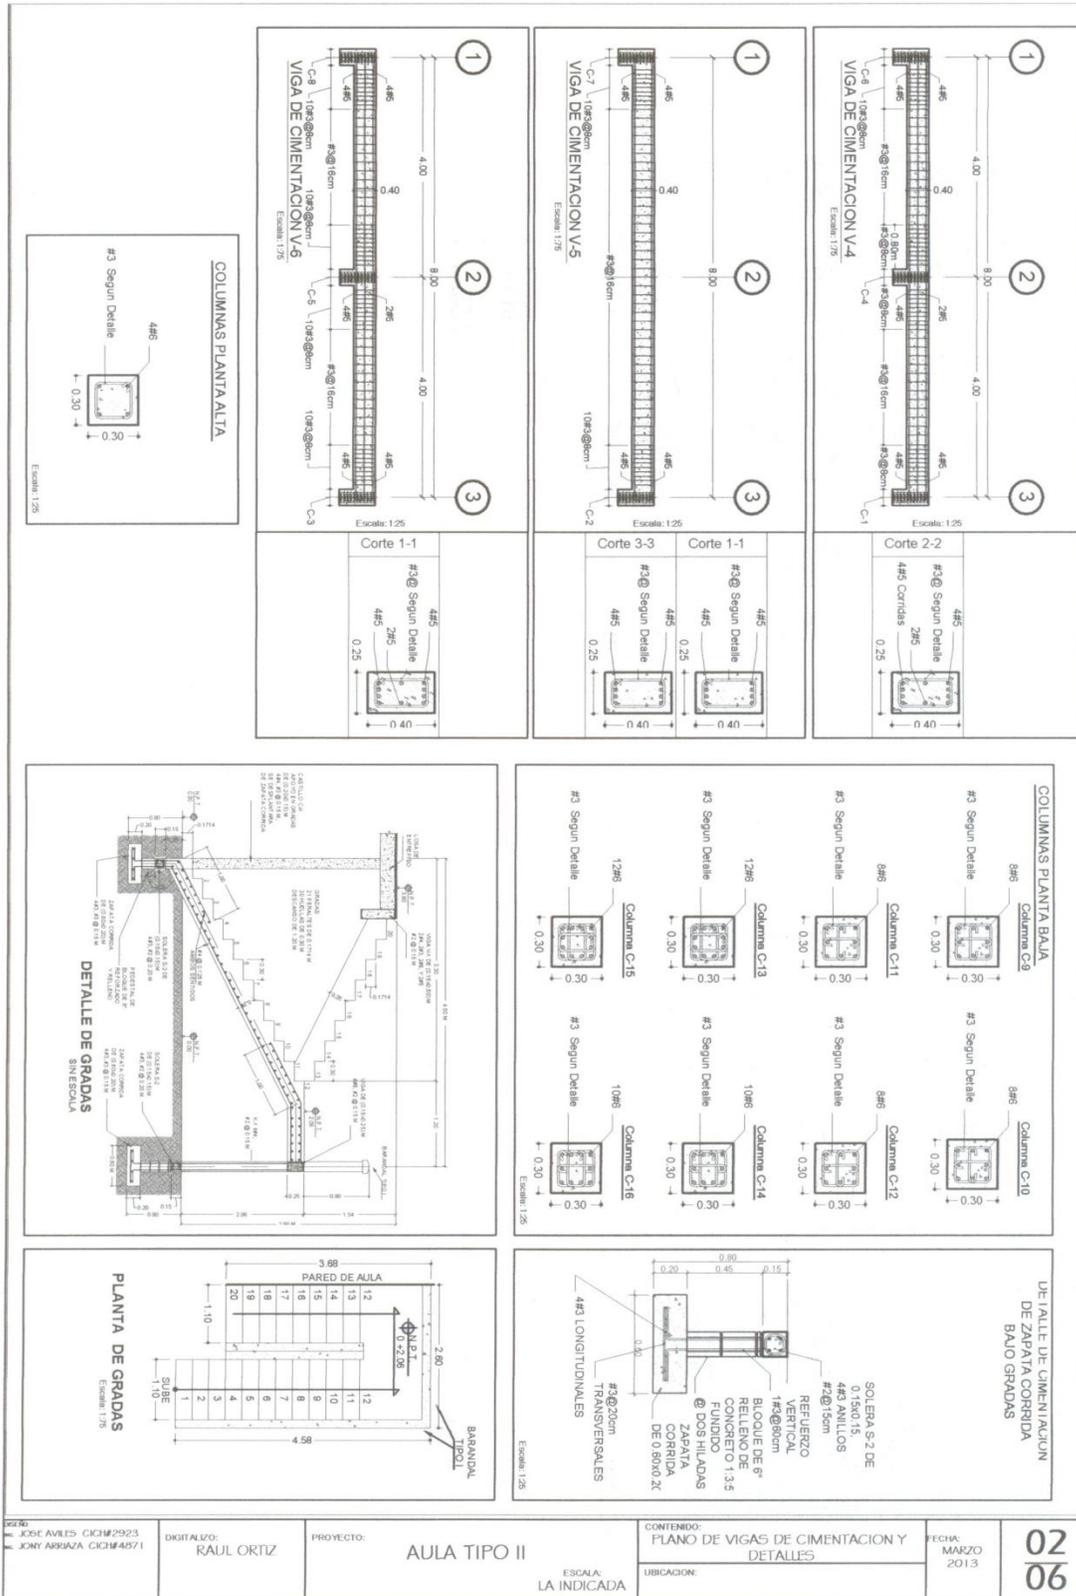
Plano de Cimentaciones Centro Escolar Aula Tipo II Niveles 7X8m
